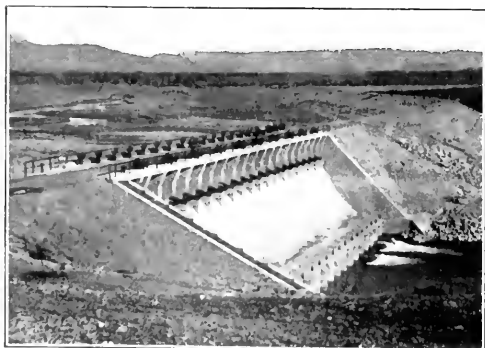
SECCIÓN DE MAMPOSTERÍA CON LAS COMPUERTAS
